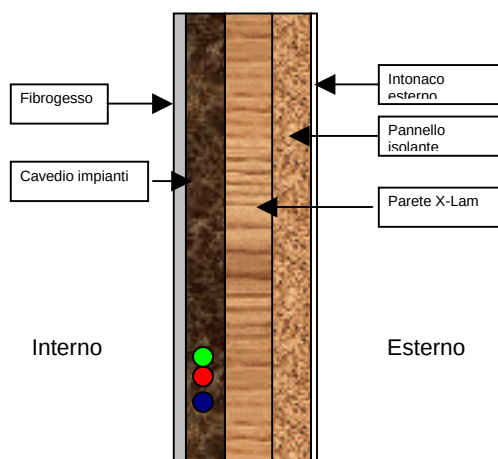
Schema di parete in X-Lam + cappotto esterno e cavedio impianti
